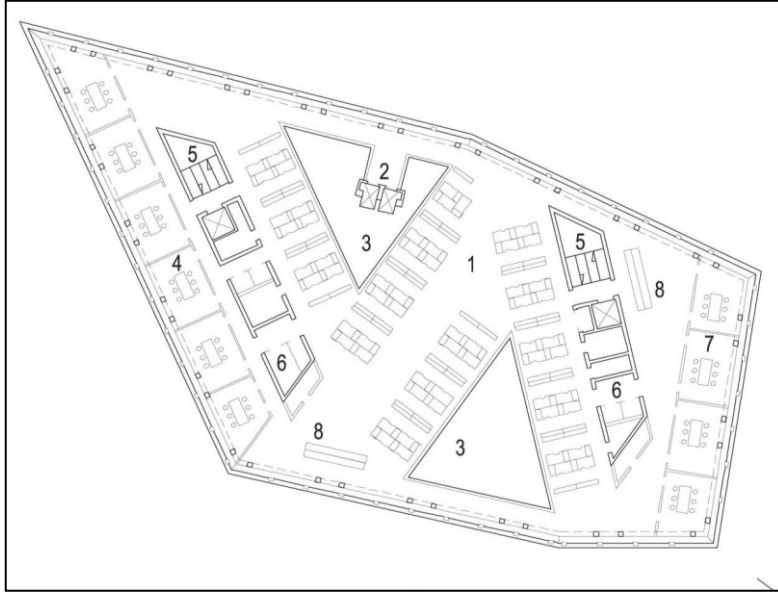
Kristal ofis binası zemin kat planı (architecturenewplus/2, bt)
